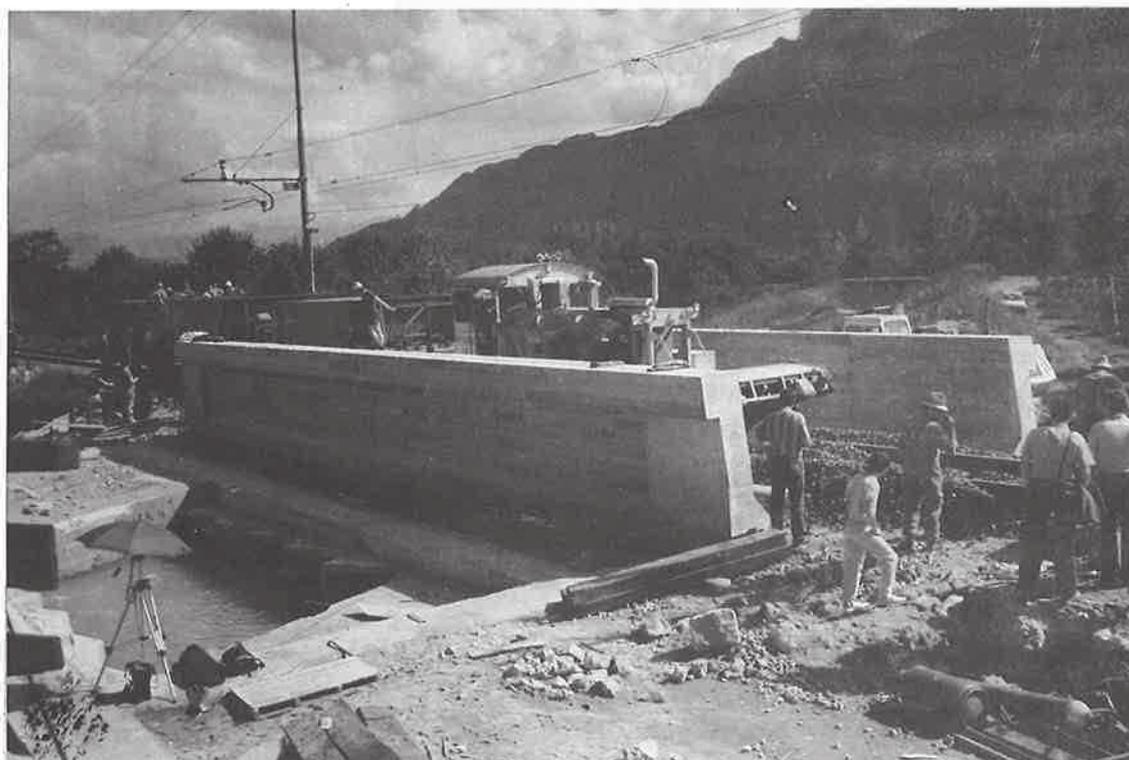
Il ponte nella sua posizione definitiva - Armamento.
